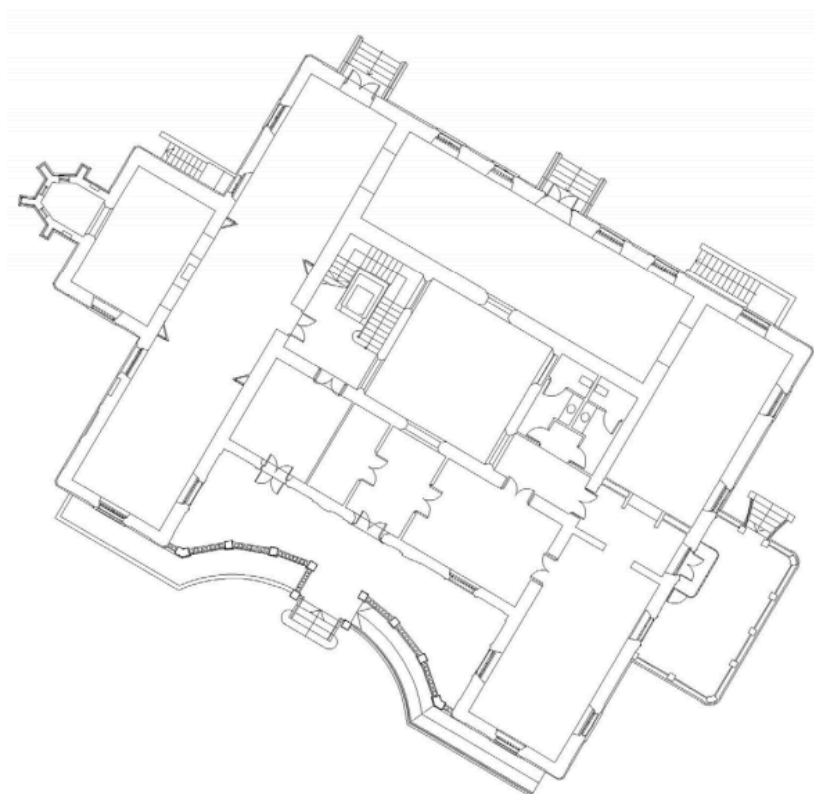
Planta de La Atalaya. Fuente: PGOU Jerez.
